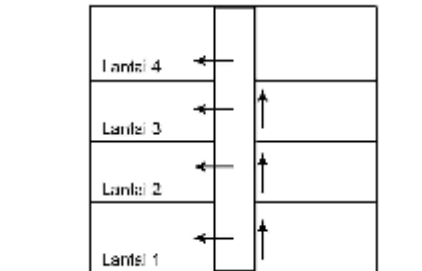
Bentuk sirkulasi horizontal dalam bangunan
